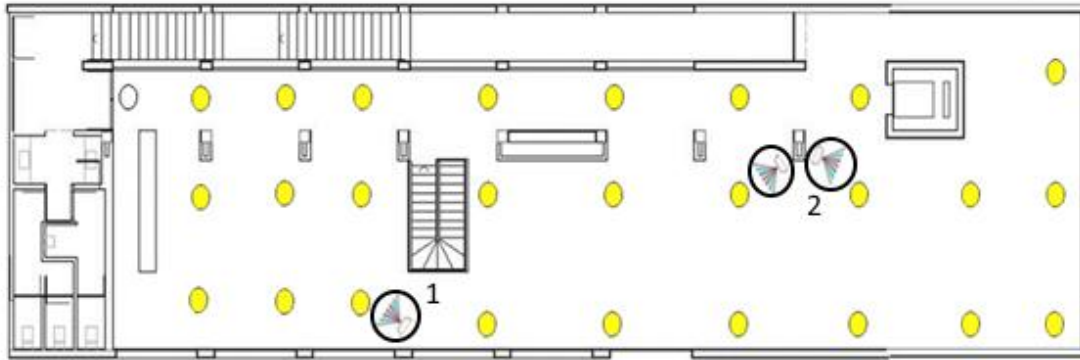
Disposição dos sensores de movimento na planta da sala de estudo
